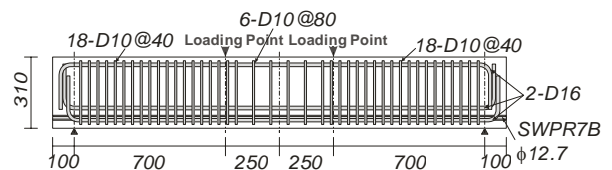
試験体詳細 (PRC 試験体) (Unit:mm)
